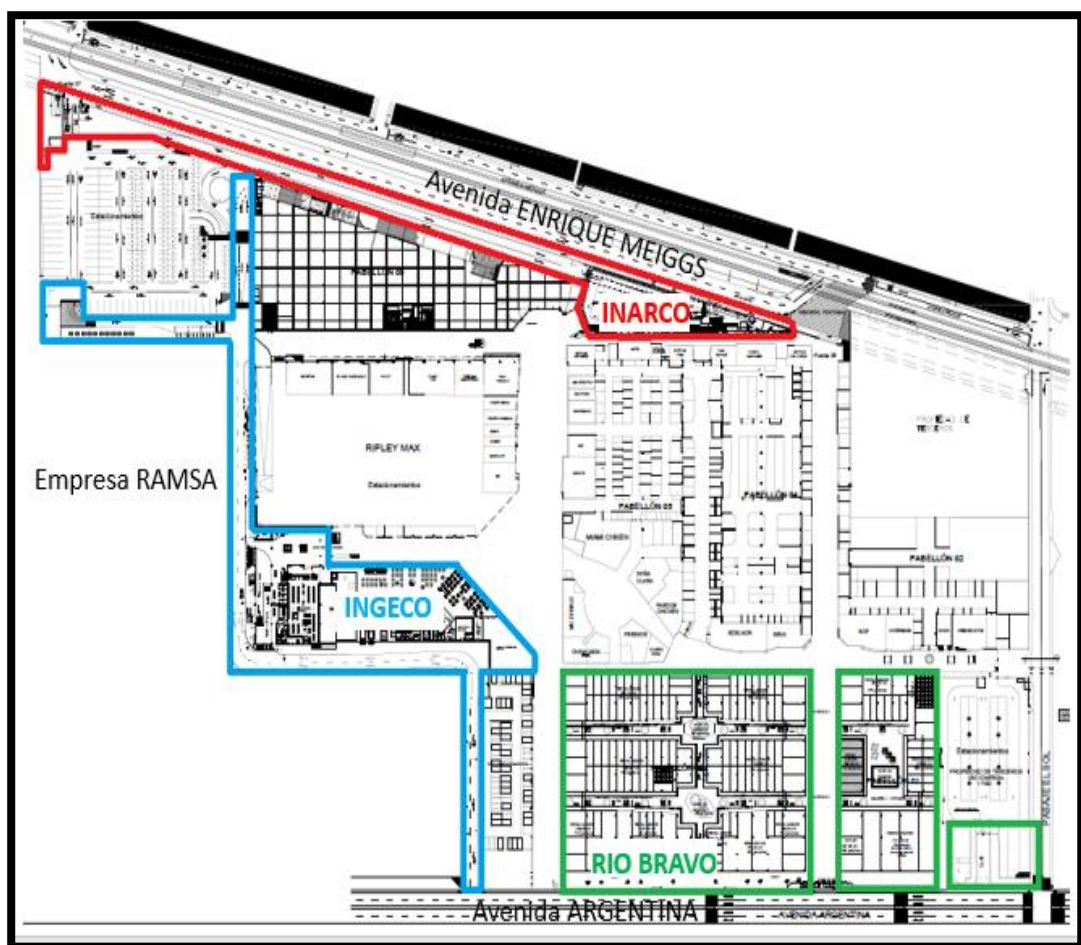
Plano de ubicación y sectorización del centro comercial
